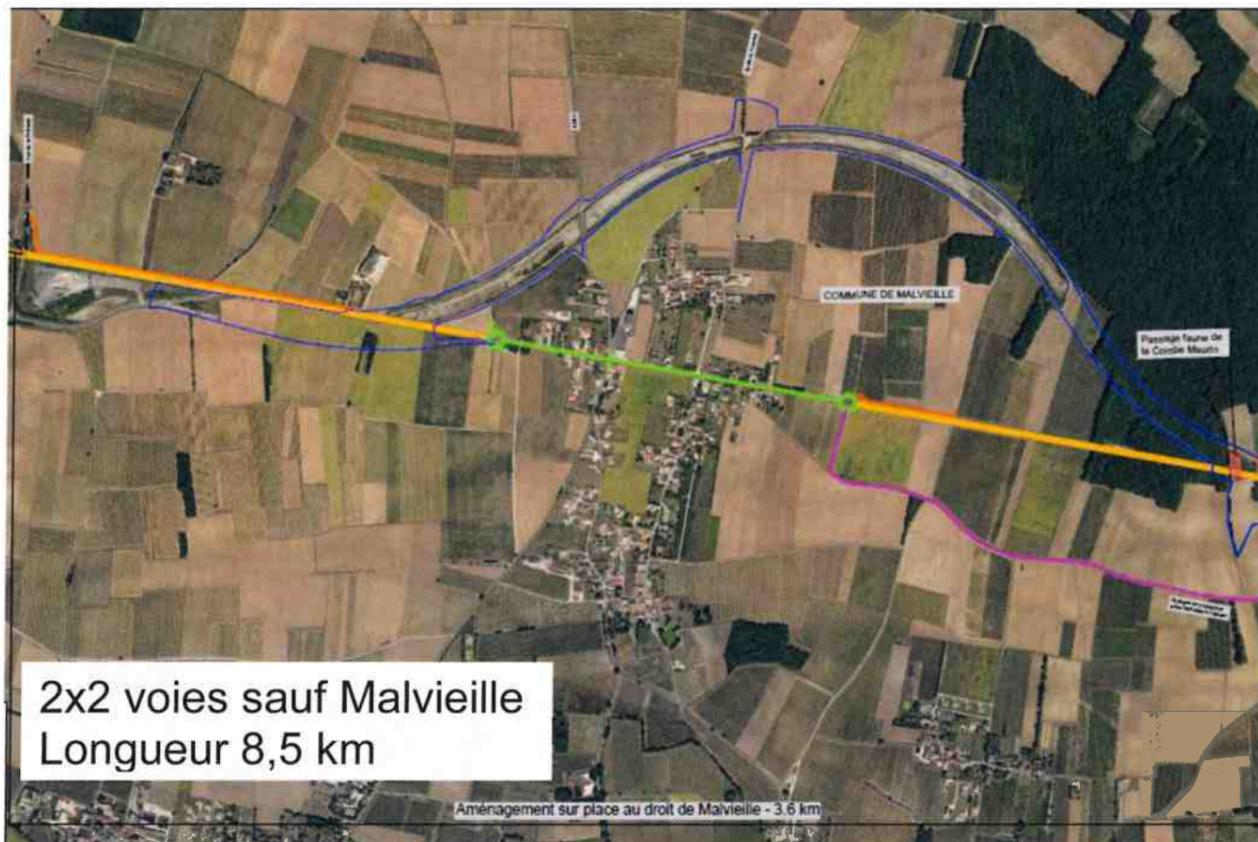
Plan variante aménagement sur place de Malvieille et Hiersac
